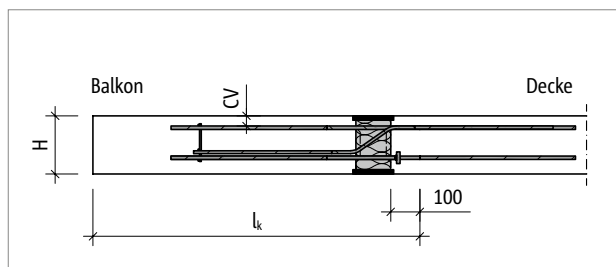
Schöck Isokorb® XT Typ CL: Statisches System
